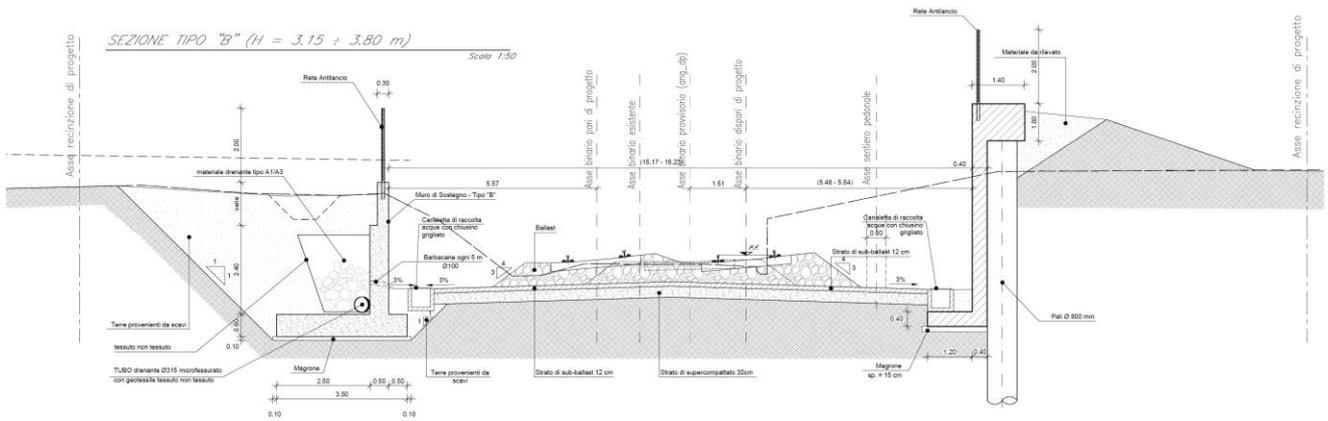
Muro di sostegno lato BP dal km 30+303.99 al km 30+392.82– sezione tipo
